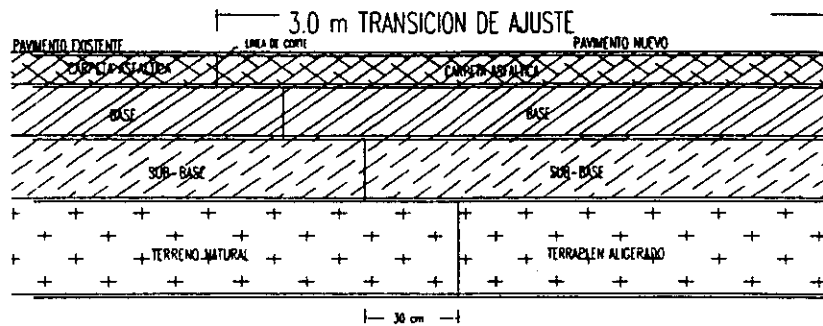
CONEXIÓN CON PAVIMENTO EXISTENTE
